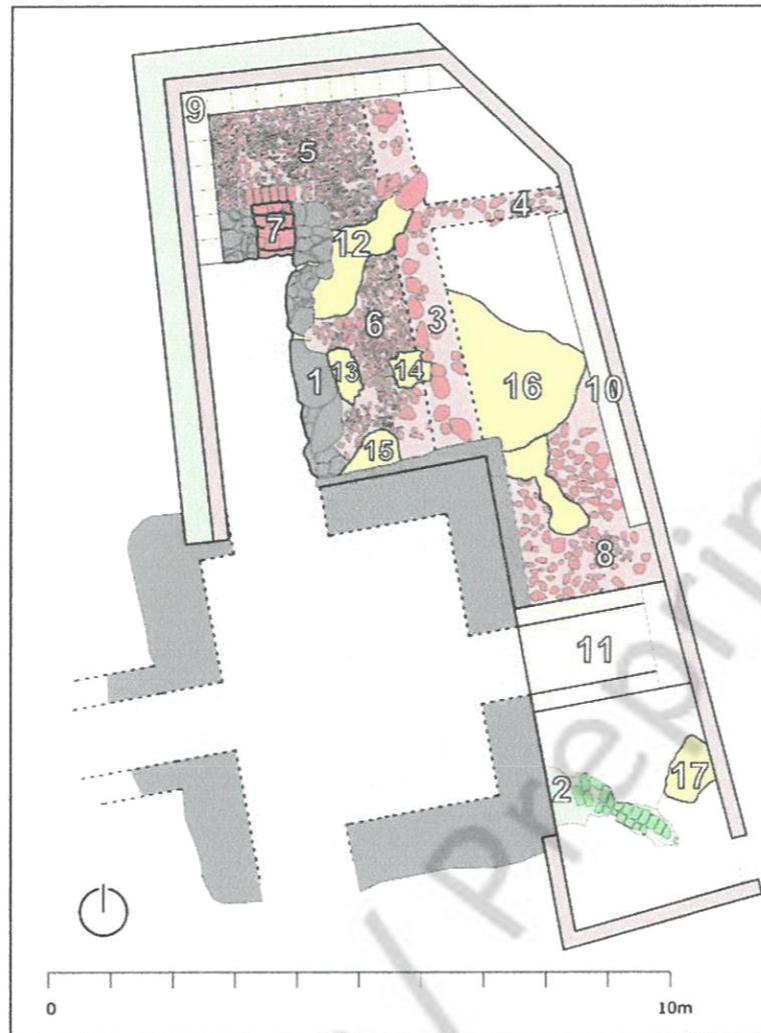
PLANTA GENERAL EN EL INTERIOR DEL RECINTO DE LOS BAÑOS
